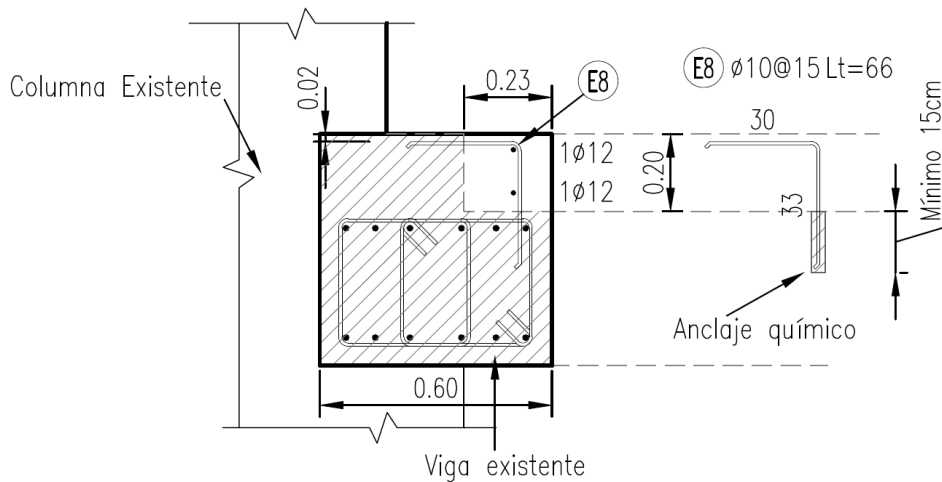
Ingeniería de detalle en sección transversal de refuerzo de vigas de fundación externas, línea A. Ver planos de detalle con cálculos incluidos.
